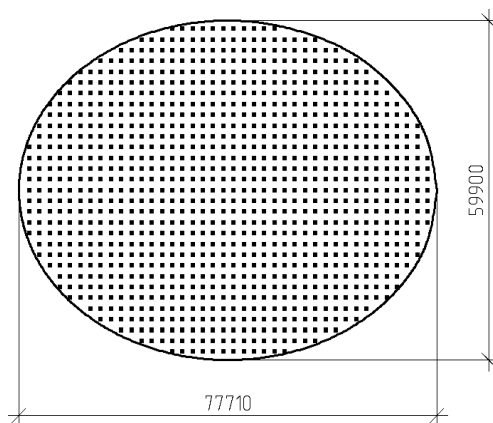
Опалубне креслення монолітної плити фундаменту
